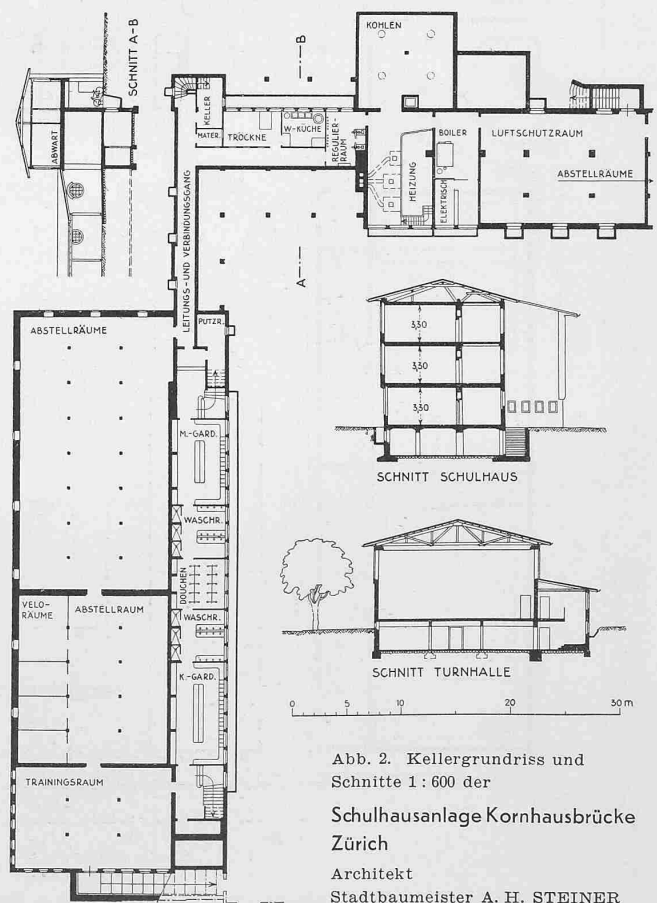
Kellergrundriss und Schnitt 1:600 der
